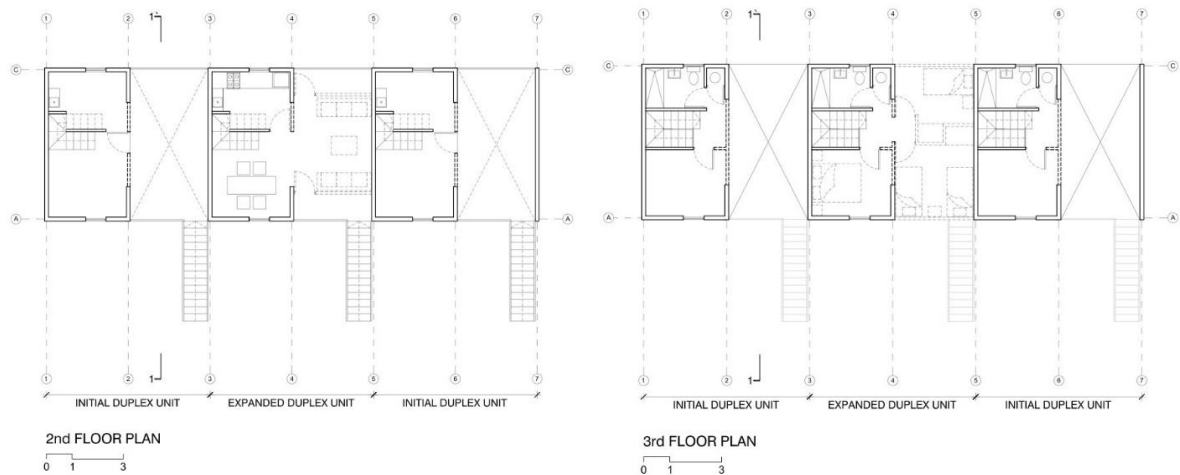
Planta tipo do segundo e terceiro pavimento das *Viviendas*.
